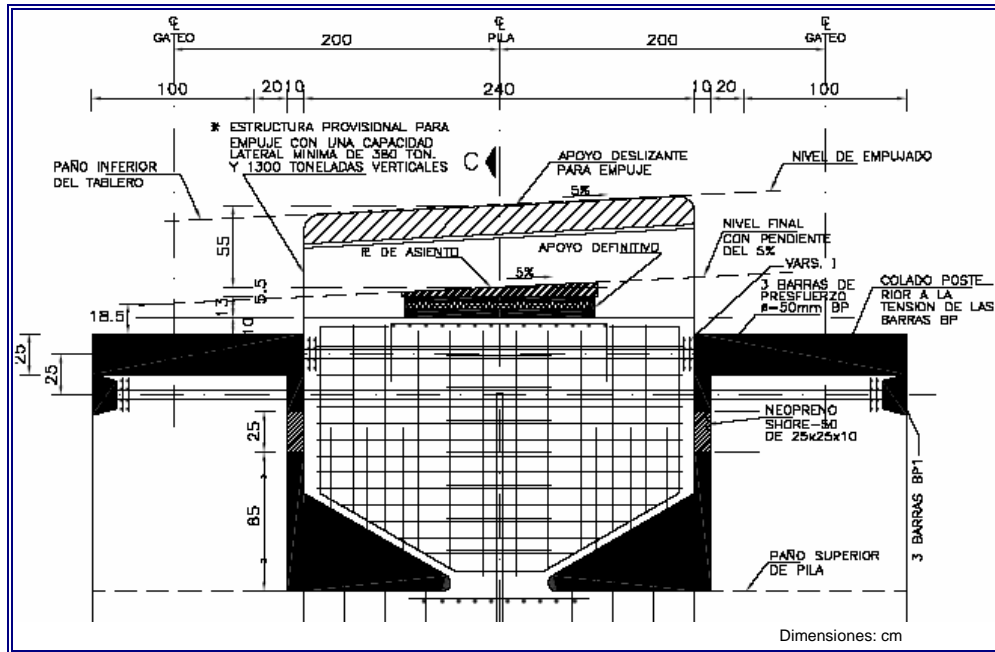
Corte transversal del cabezal la intrados, pilas 2 y 3
